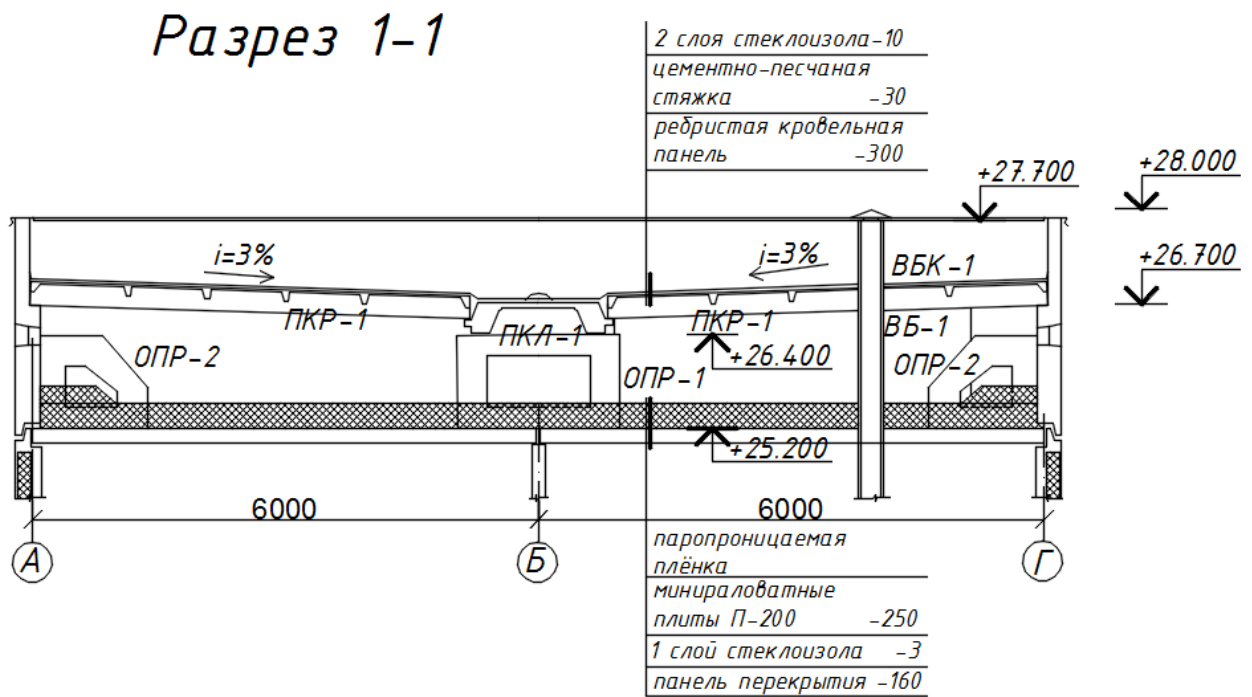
Холодный чердак и безрулонная кровля. Поперечный разрез
